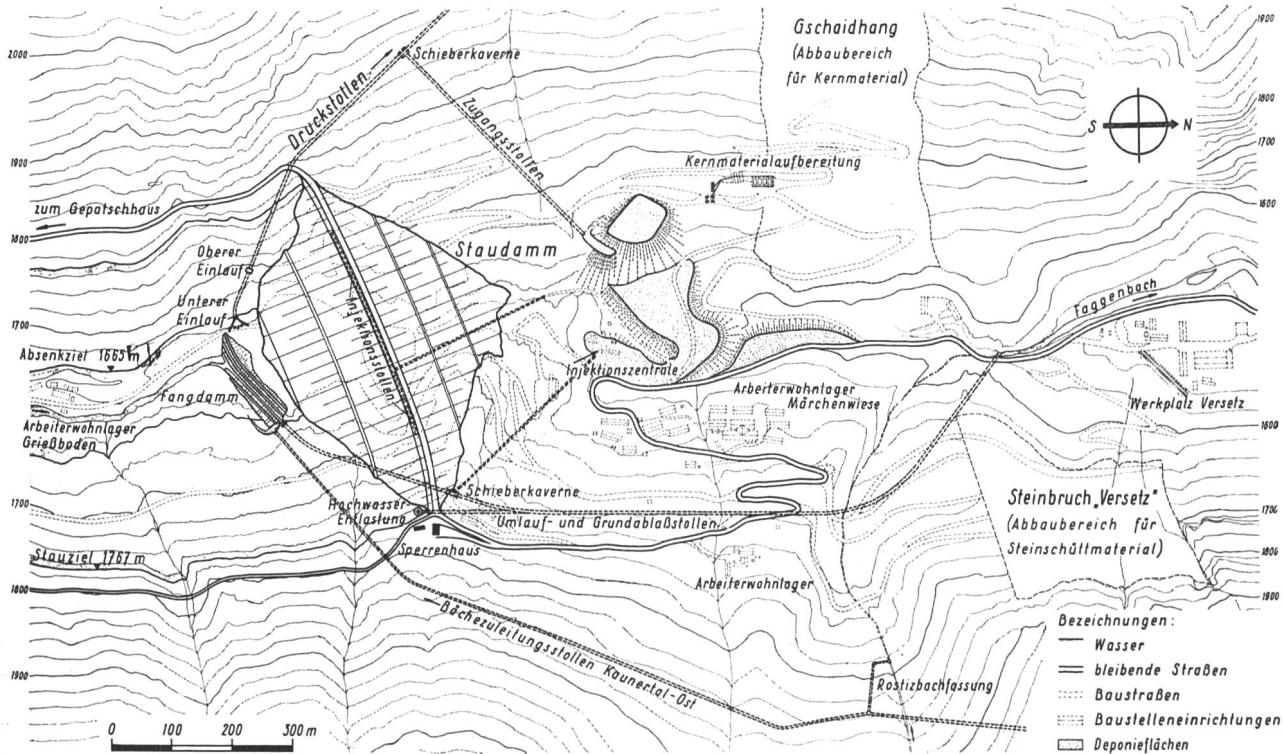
Lageplan Staudamm Gepatsch und Bau-Installations im Kaunertal
